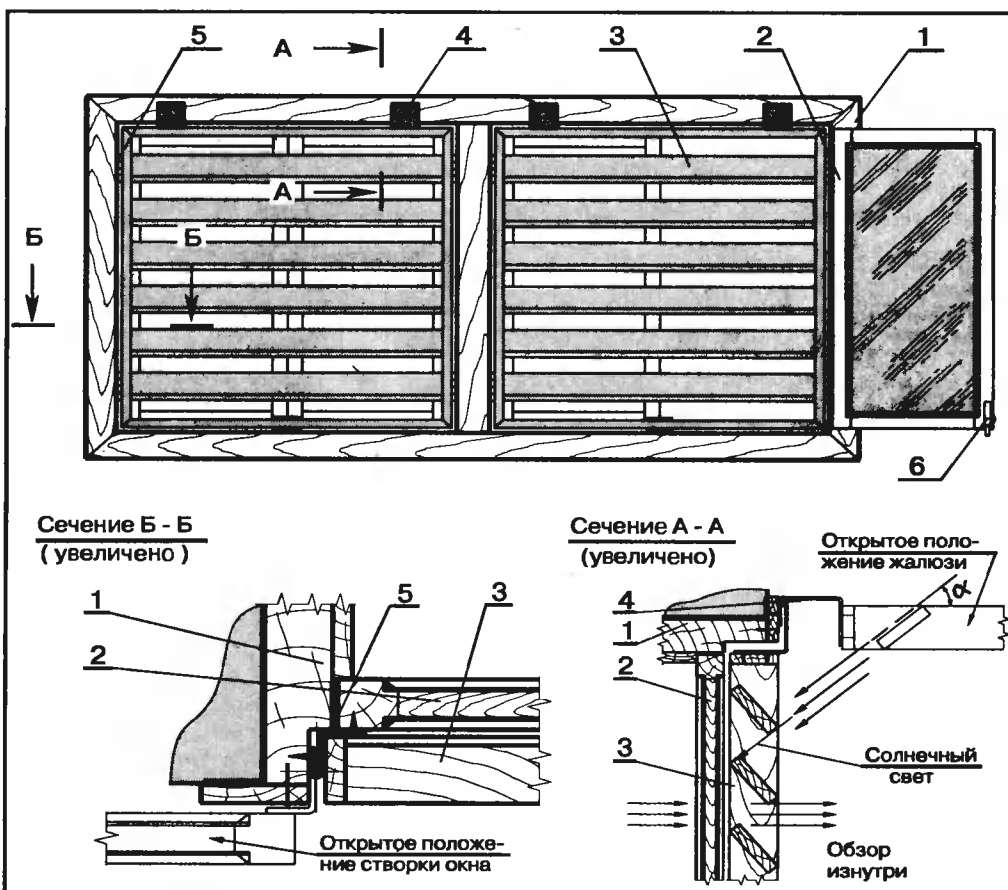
Конструкция оконного блока с двойным остеклением и решеткой жалюзи: 1 — коробка; 2 — створка; 3 — жалюзи; 4, 5 — шарниры; 6 — шпингалет
